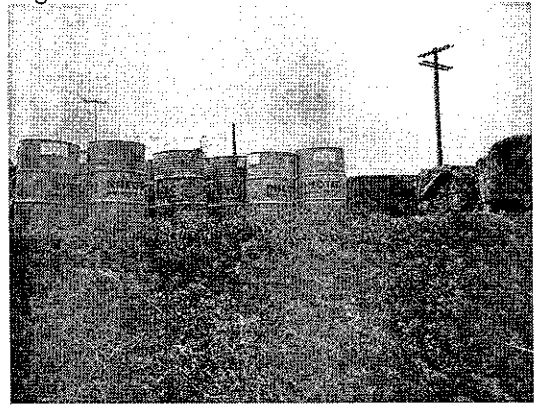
Lote 27/SC – Usina de concretagem – bacia de decantação.
